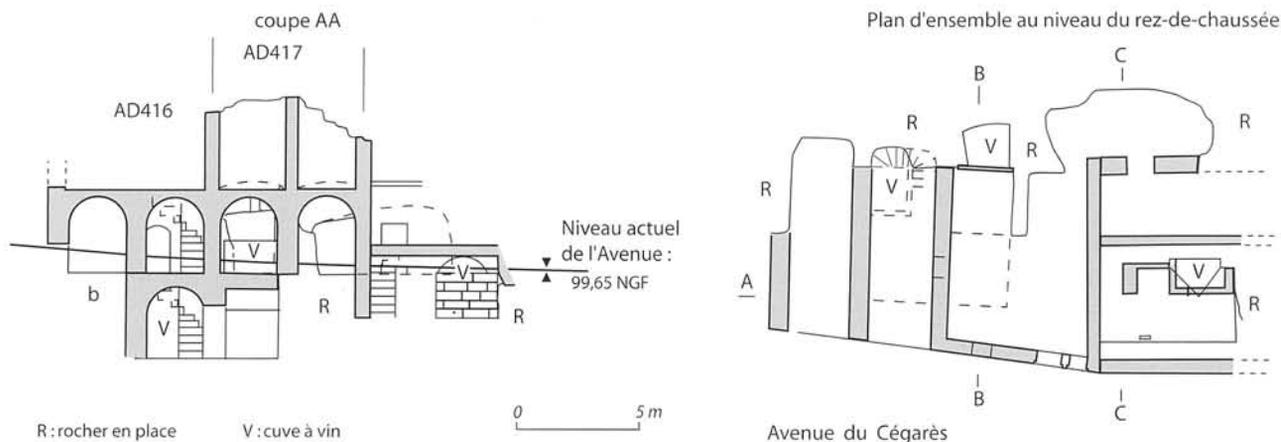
ROGNES, Le Foussa. Plan d'ensemble et coupe AA.
